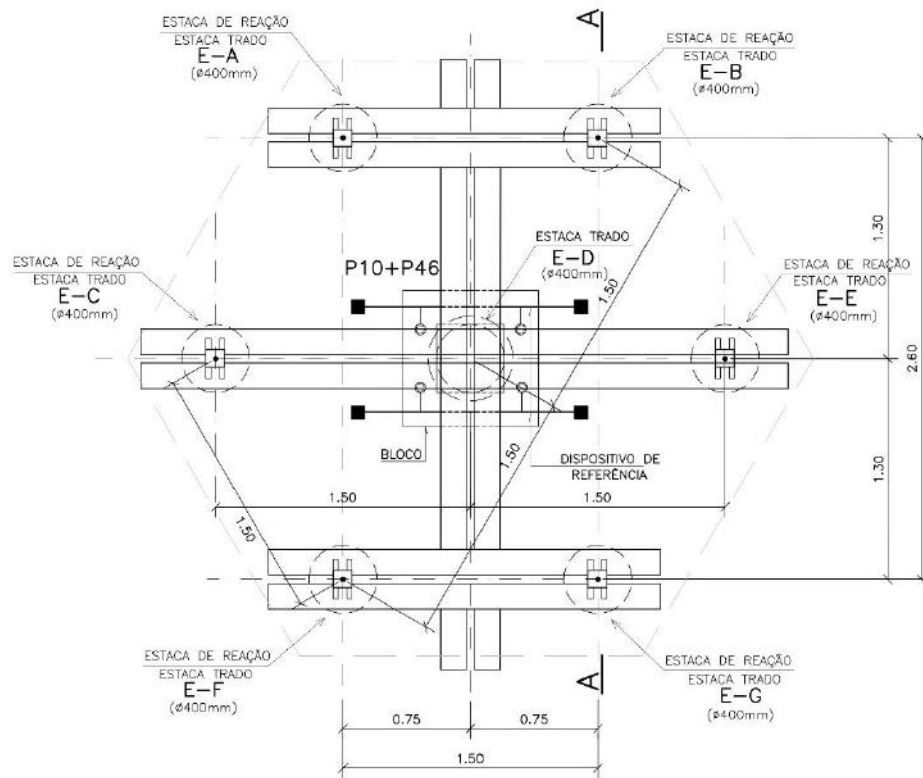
Sistema em planta para Prova de Carga (Concreta, 2023)
